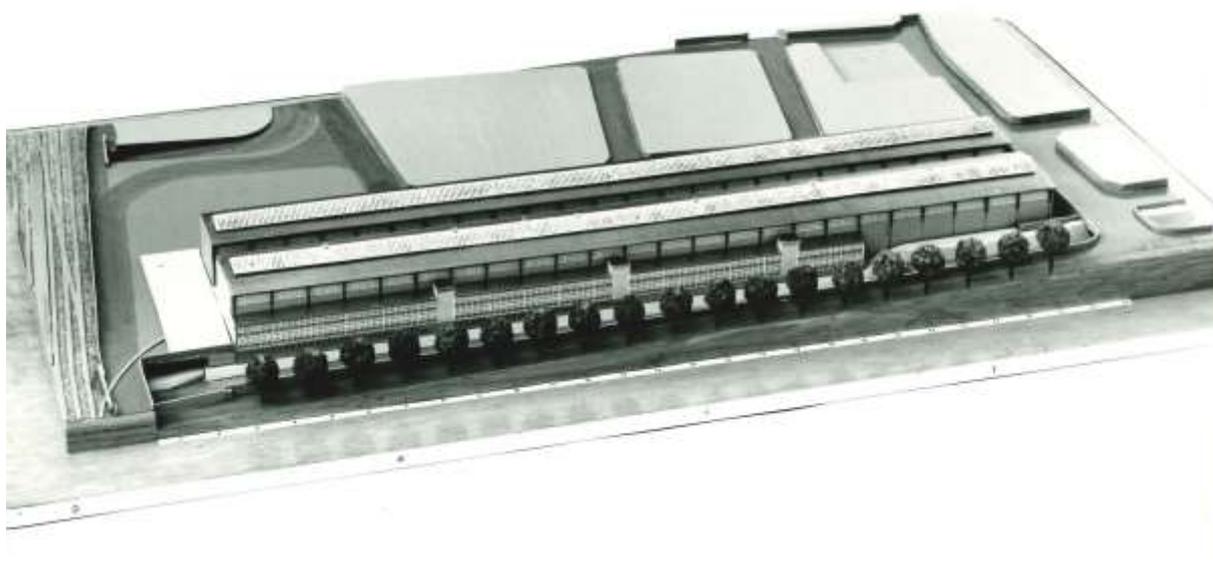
Maquette extension maximum, 7 juillet 1969 (AVV, 96.01, Fonds ACMV).
